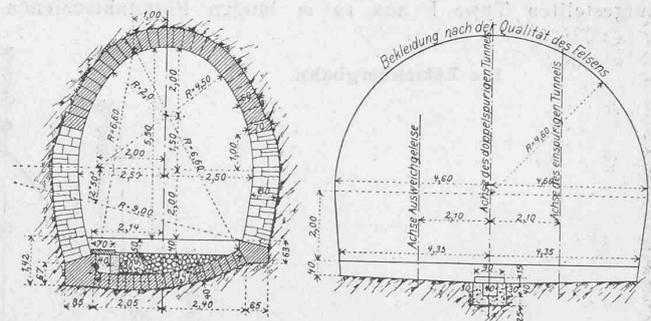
u. 7. Tunnelprofile zu Projekt I. — 1:200.
